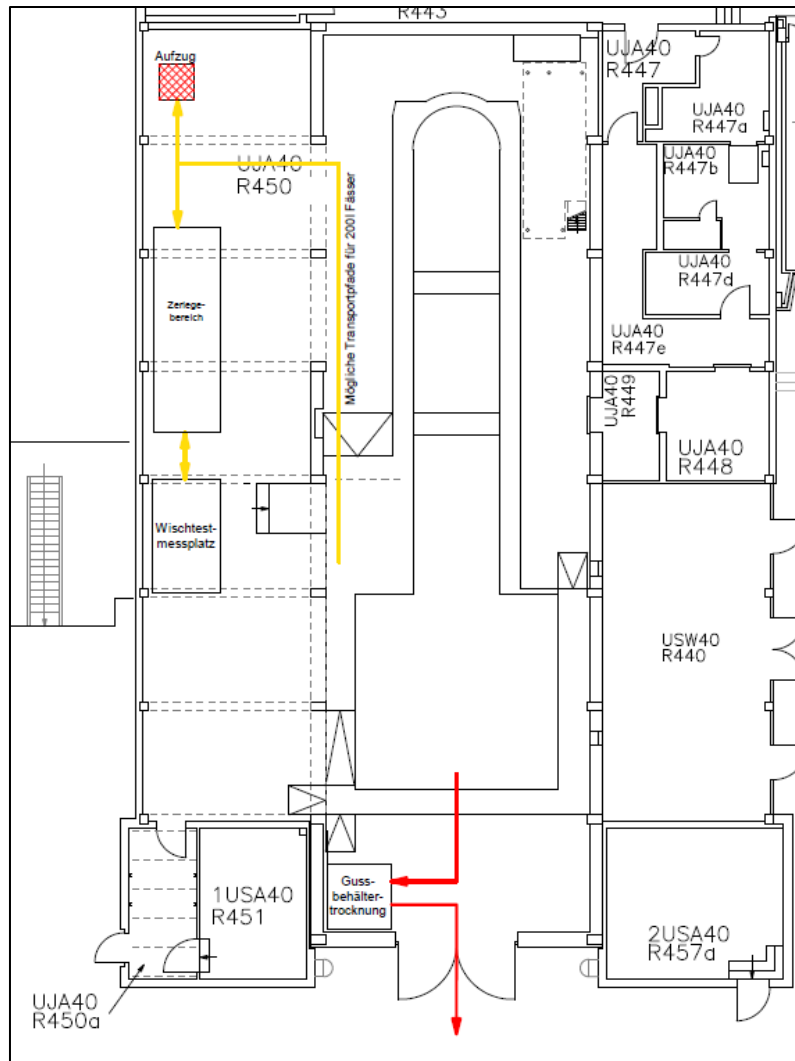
Ausschnitt Reaktorhalle (+9,0 m) mit Aufzugsposition, Sortier- und Nachbearbeitungsbereich
